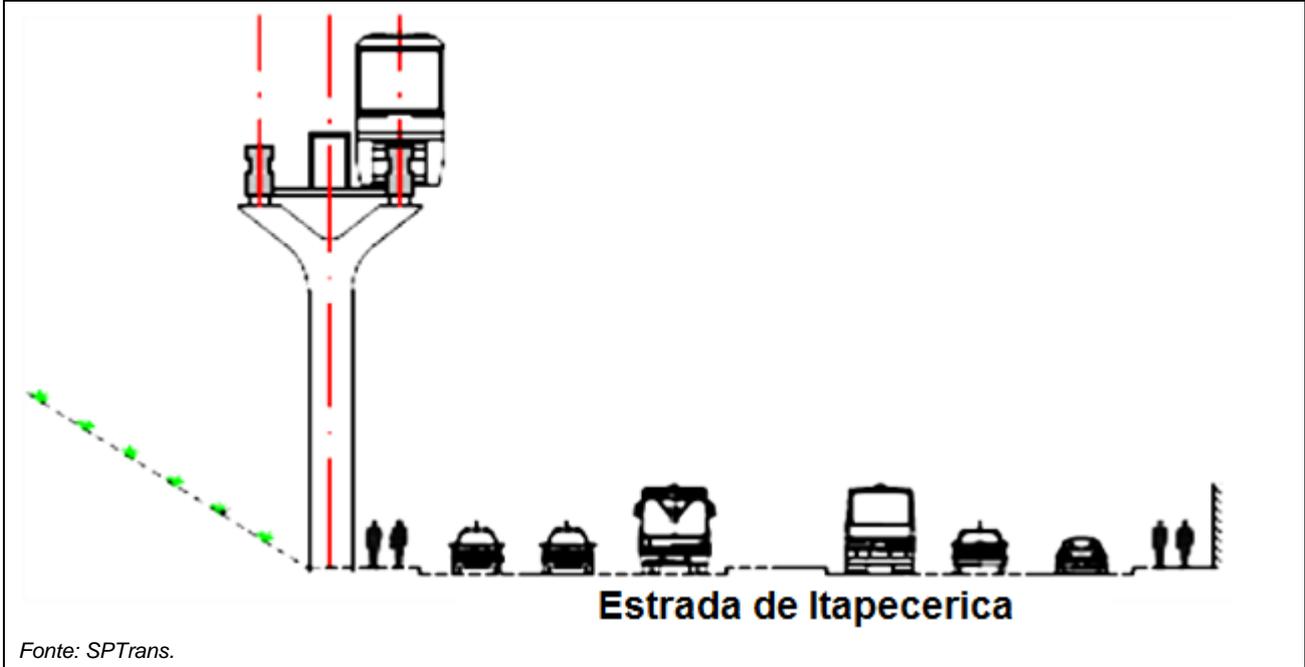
SUB TRECHO PARALELO À AV. CARLOS CALDEIRA – SEÇÃO TIPOb) Trecho Capão Redondo ao Terminal Vila Ângela – Trecho 2
